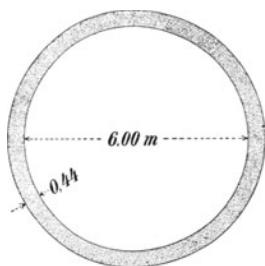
Stampfbeton. (Zulässige Beanspruchung 20 kg/qcm.)
